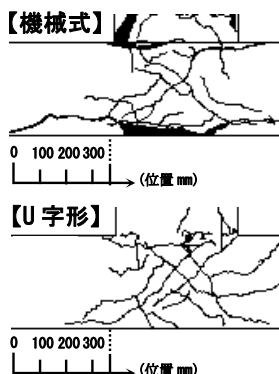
最大耐力時ひび割れ状況(実験)
